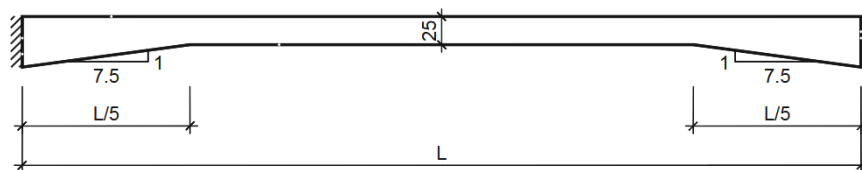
35 Géométrie type des dalles entre poutres modélisées
